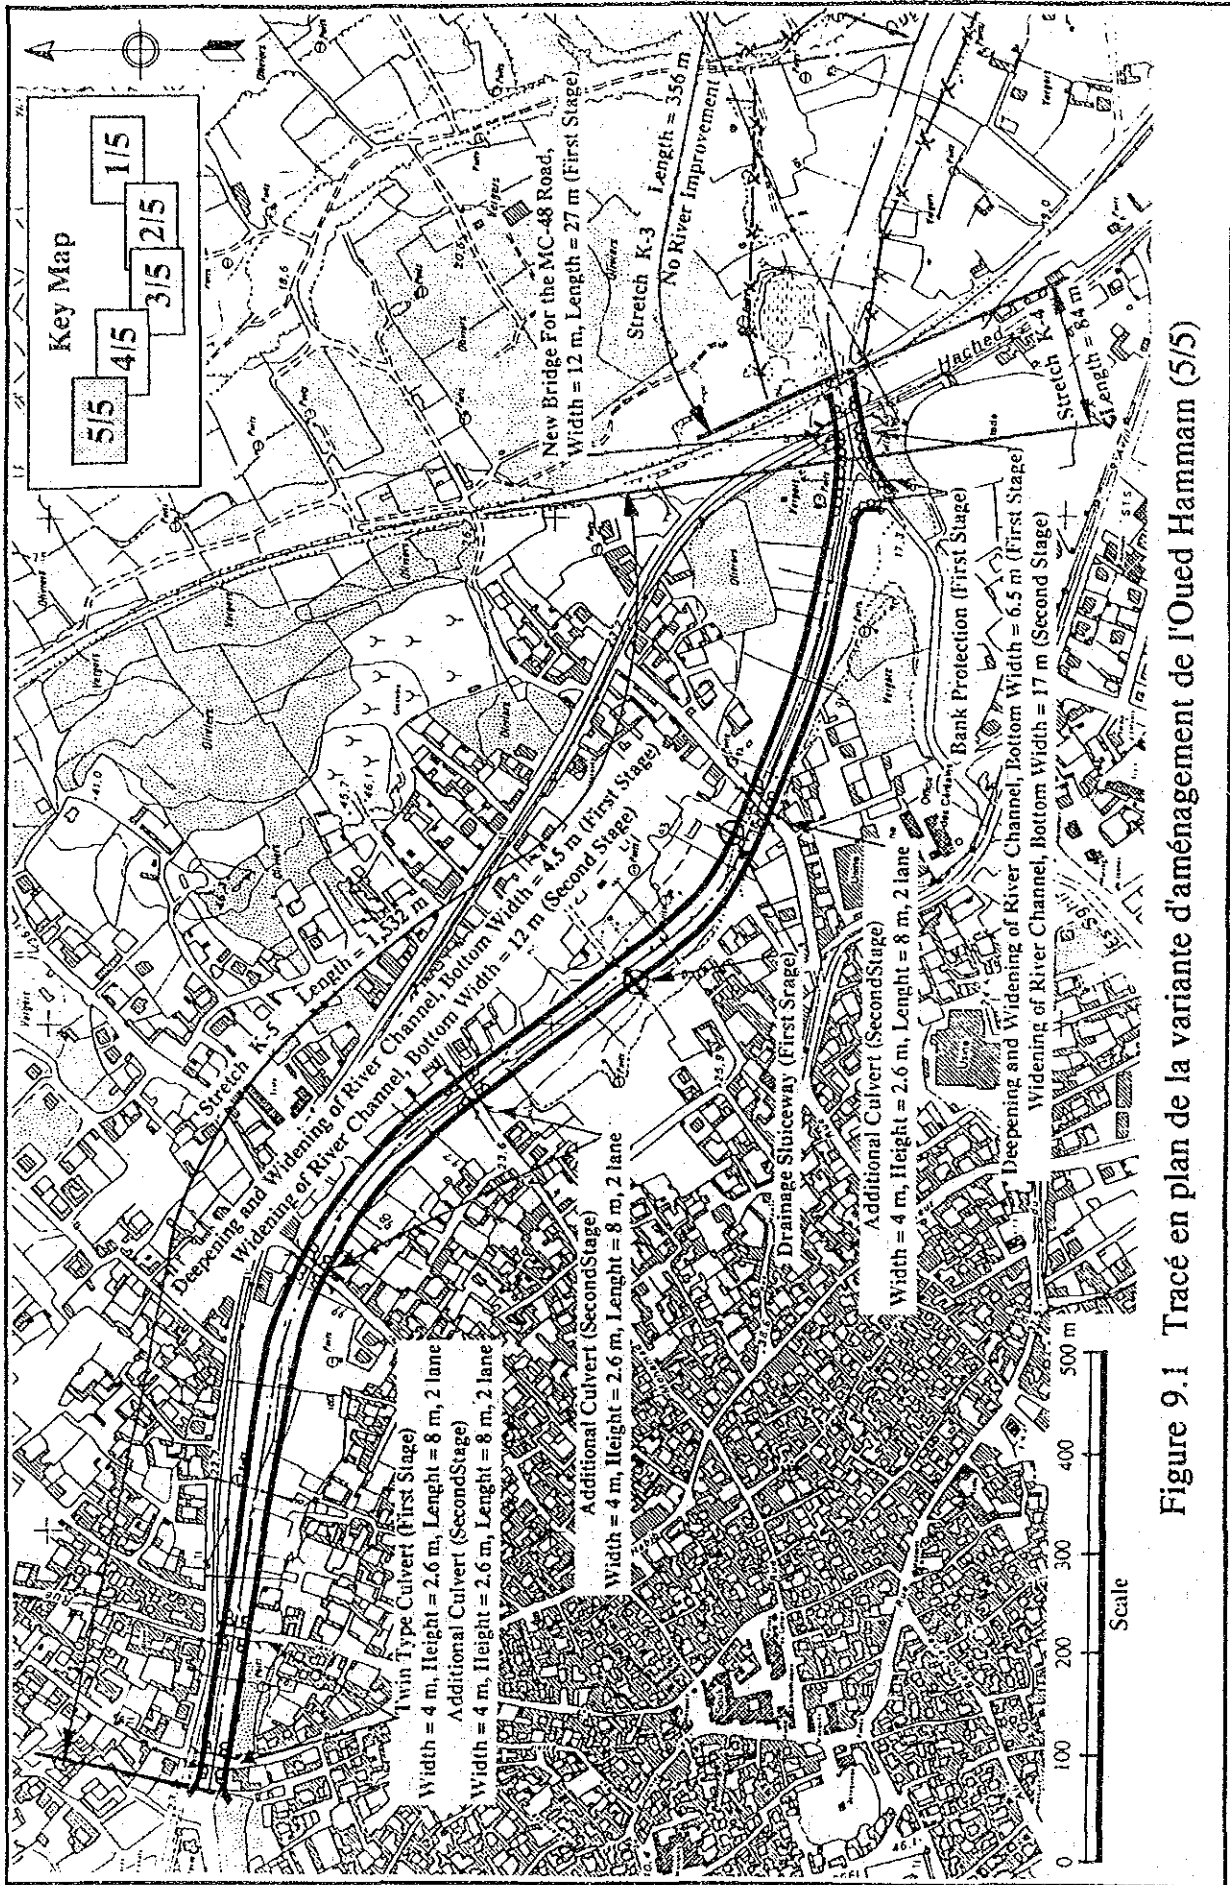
Tracé en plan de la variante d'aménagement de l'Oued Hammam (5/5)
